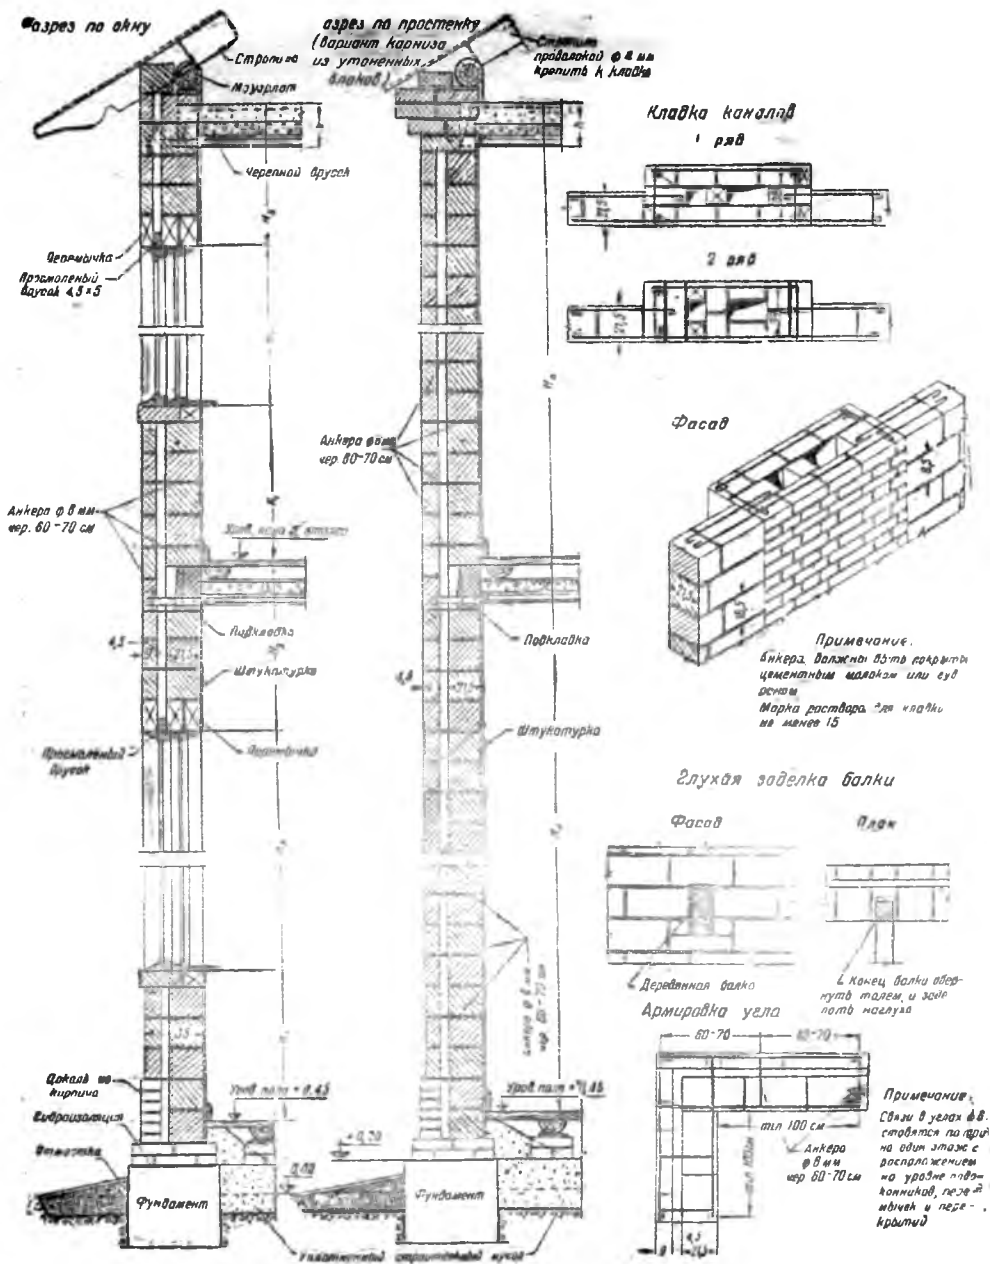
Стены с воздушным прослойком из разных блоков. Разрезы по двухэтажной стене, детали кладки каналов, заделки балок и армирования углов
